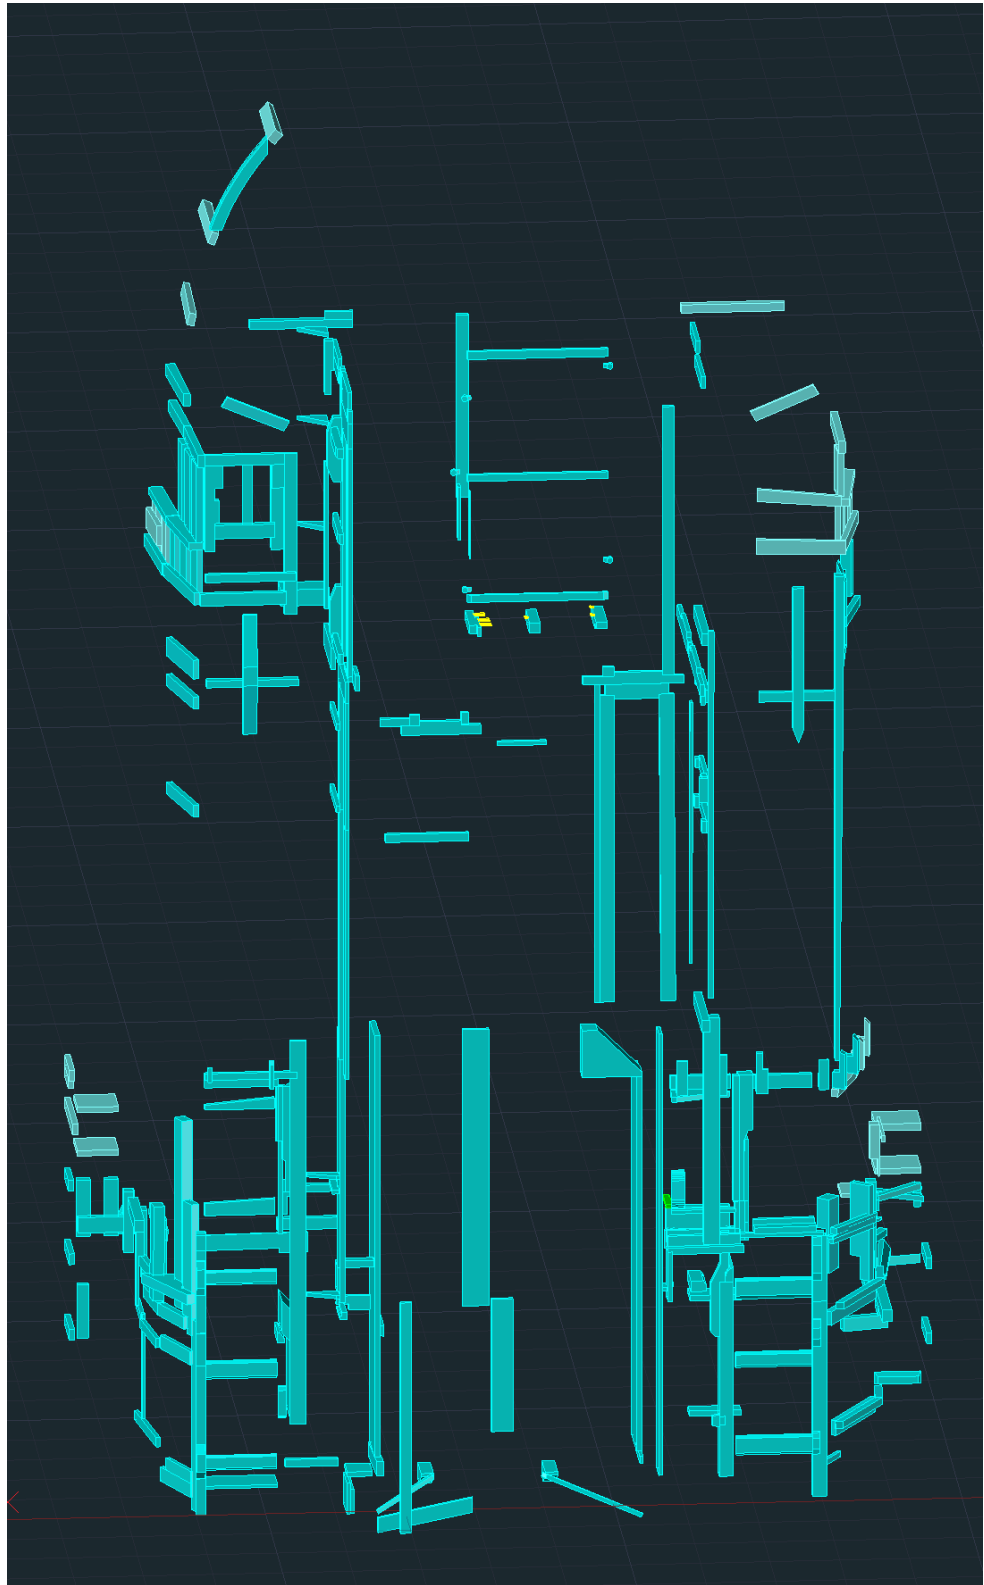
Desenho AutoCAD 3D, elementos de união - vista de frente
